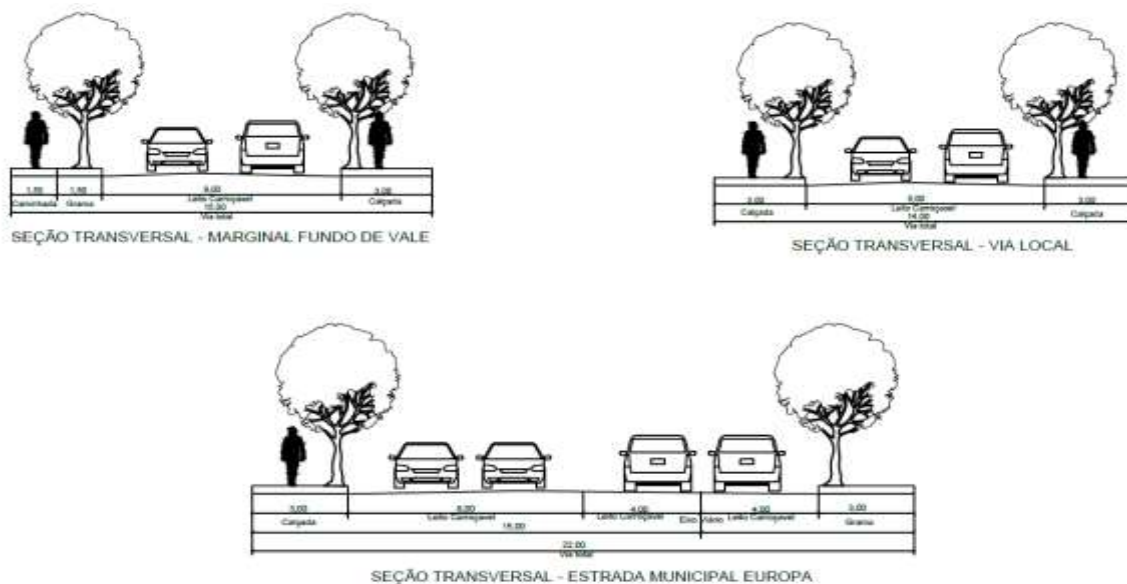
Perfil viário a ser projetado para o empreendimento. Fonte: Projeto.
